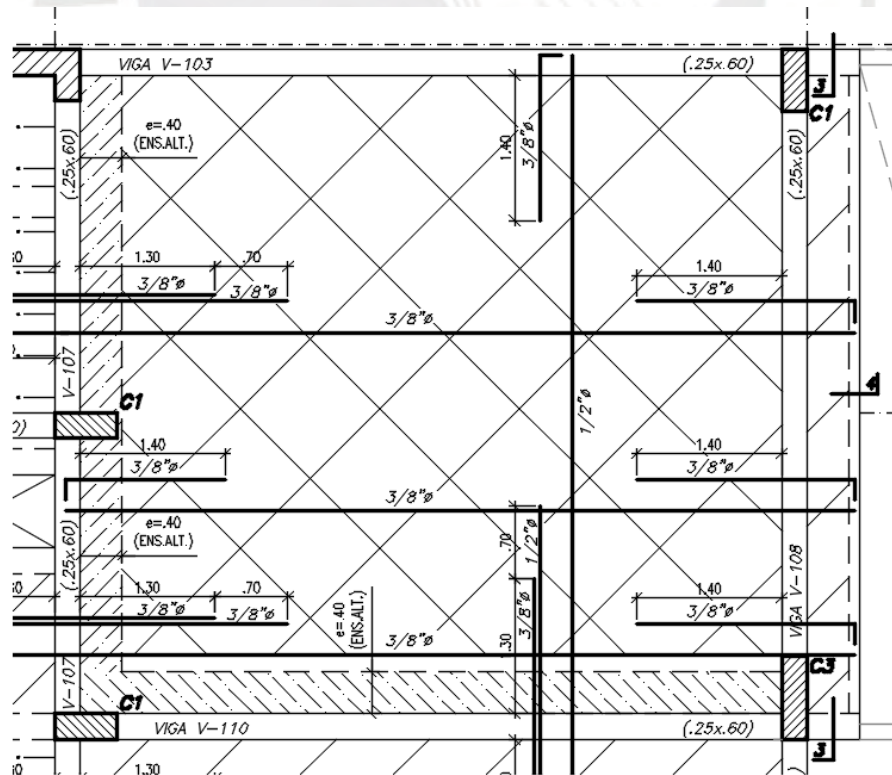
Armado de viguetas típicas de losa aligerada de 20 cm de espesor en dos direcciones.
